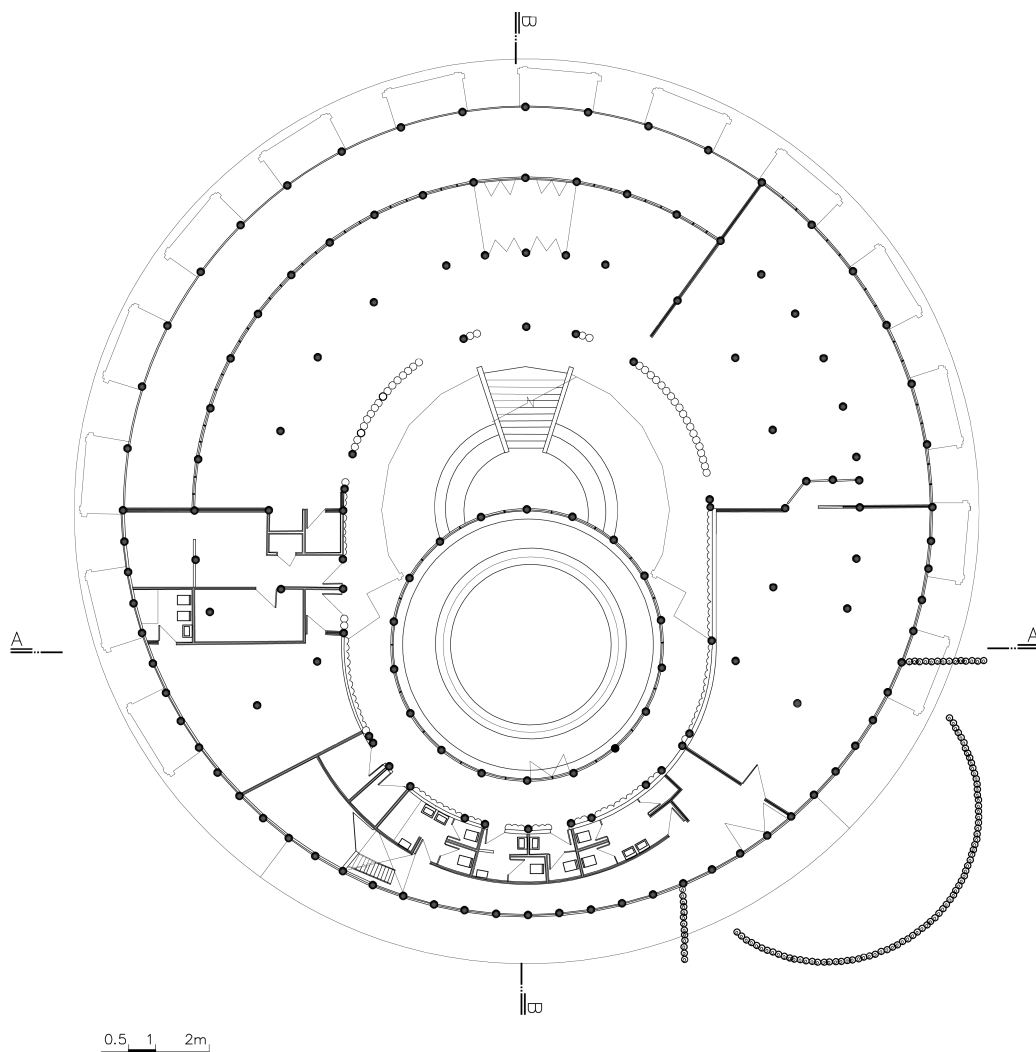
Pousada da Ilha de Silves. Planta Térreo, 2017.
